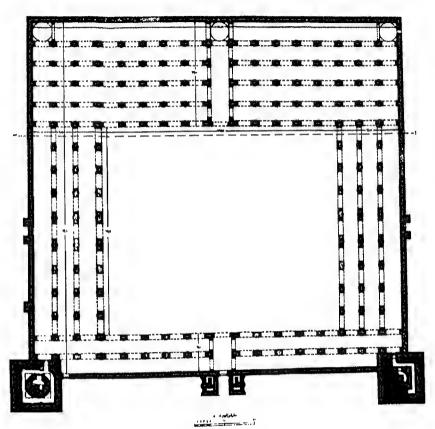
ـ مسقط أفقى لجامع ابن طولون
